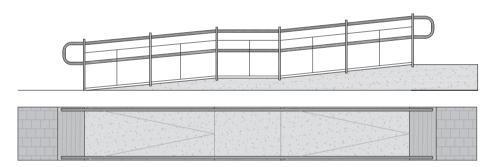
Vista en planta y sección de rampa con descanso intermedio.
